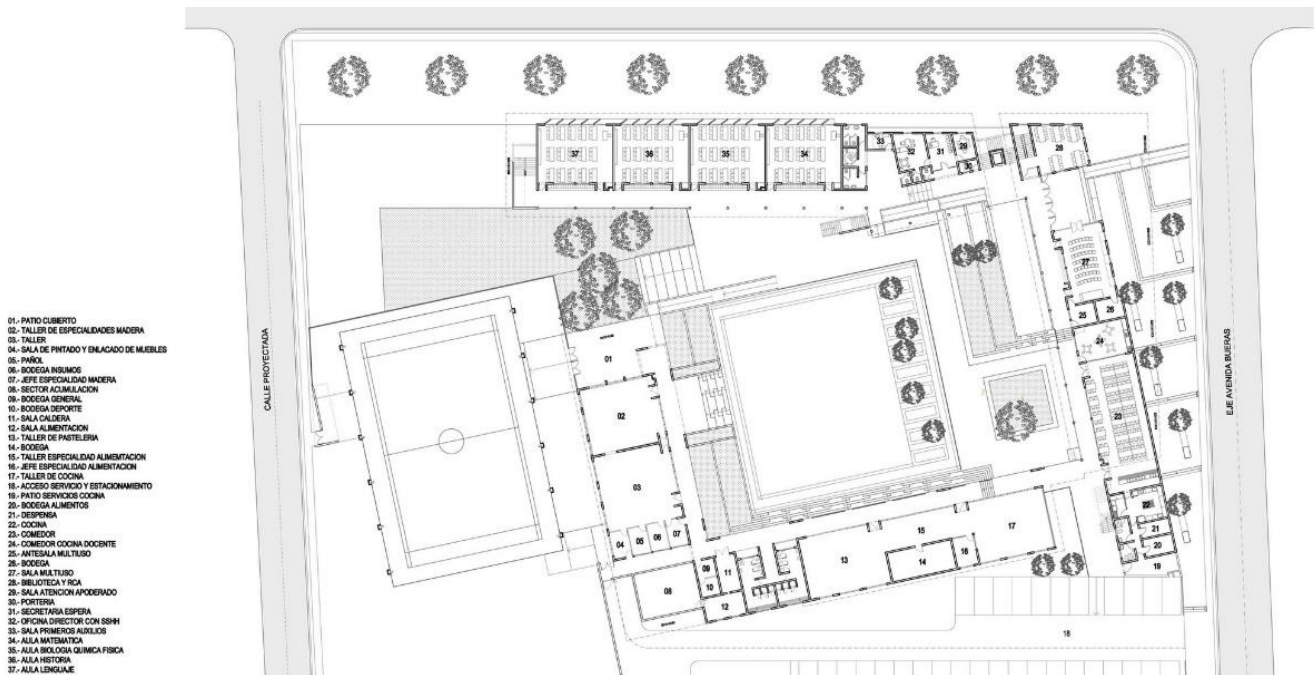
Planimetría Primer Piso. Plataforma Arquitectura.
